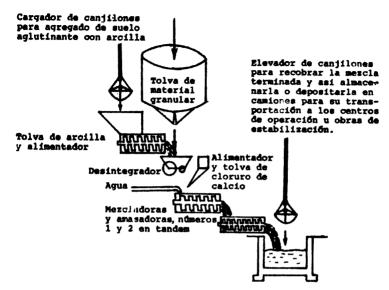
Planta mezcladora de agregados estabilizantes.
